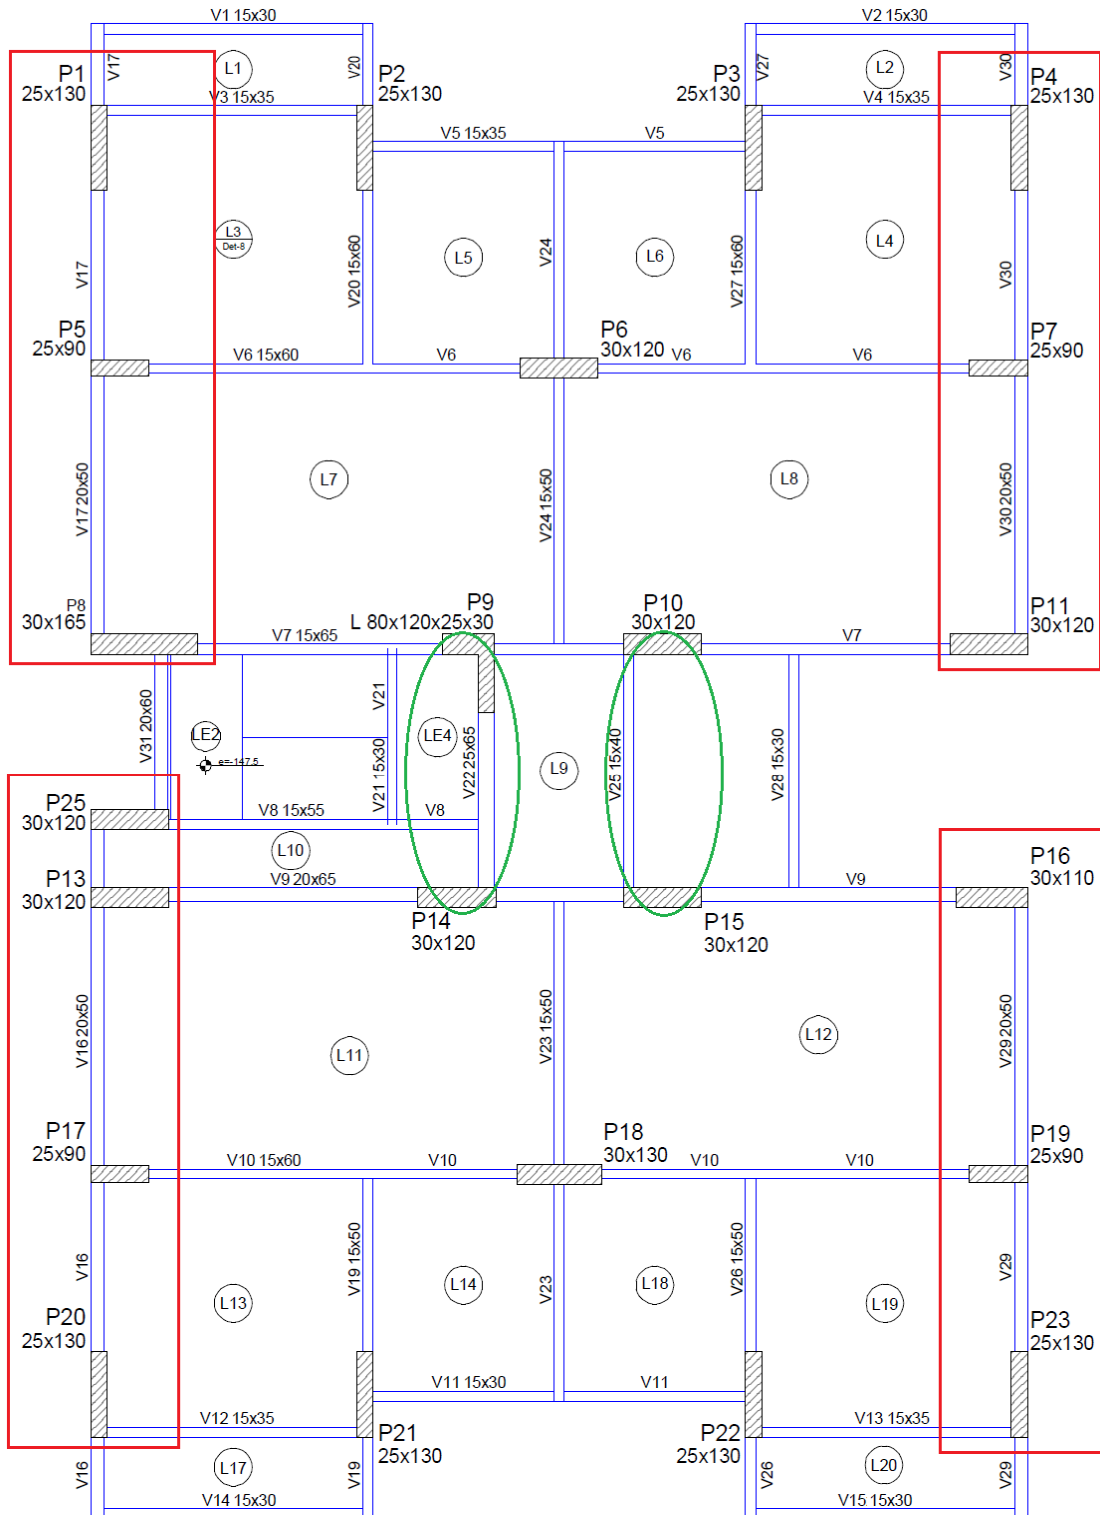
Planta de forma do pavimento tipo - Modelo Estrutural com Pórticos de contraventamento e Pilares-parede – direção “x”.
